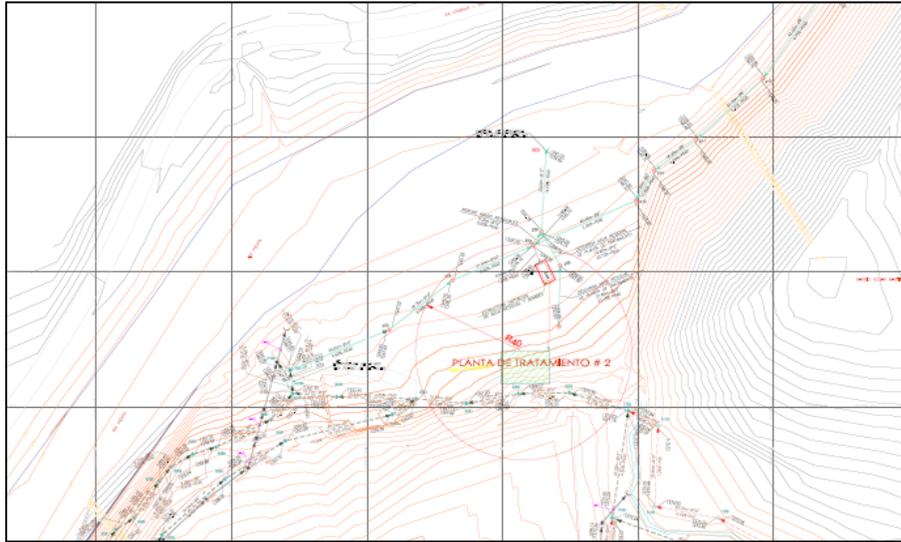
Plano Planta General – Conexión Alcantarillado A.R. a Planta de tratamiento #2
